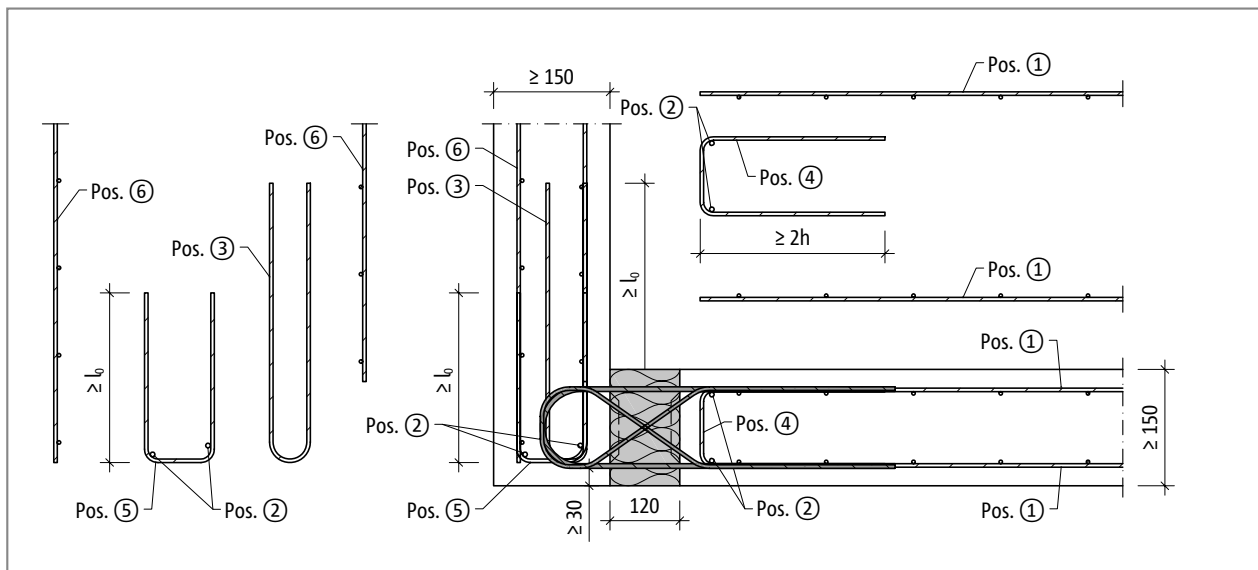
Schöck Isokorb® tipo ABXT - disposizione orizzontale, armatura in opera
